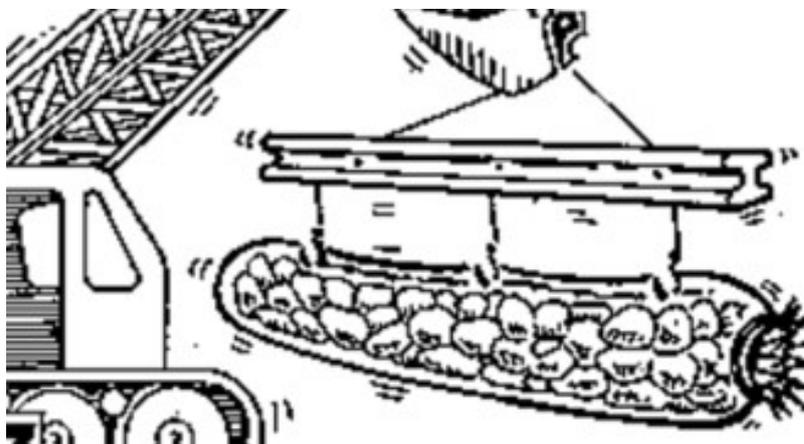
Detalhe do sistema de içamento normalmente utilizado para instalação dos gabiões saco
